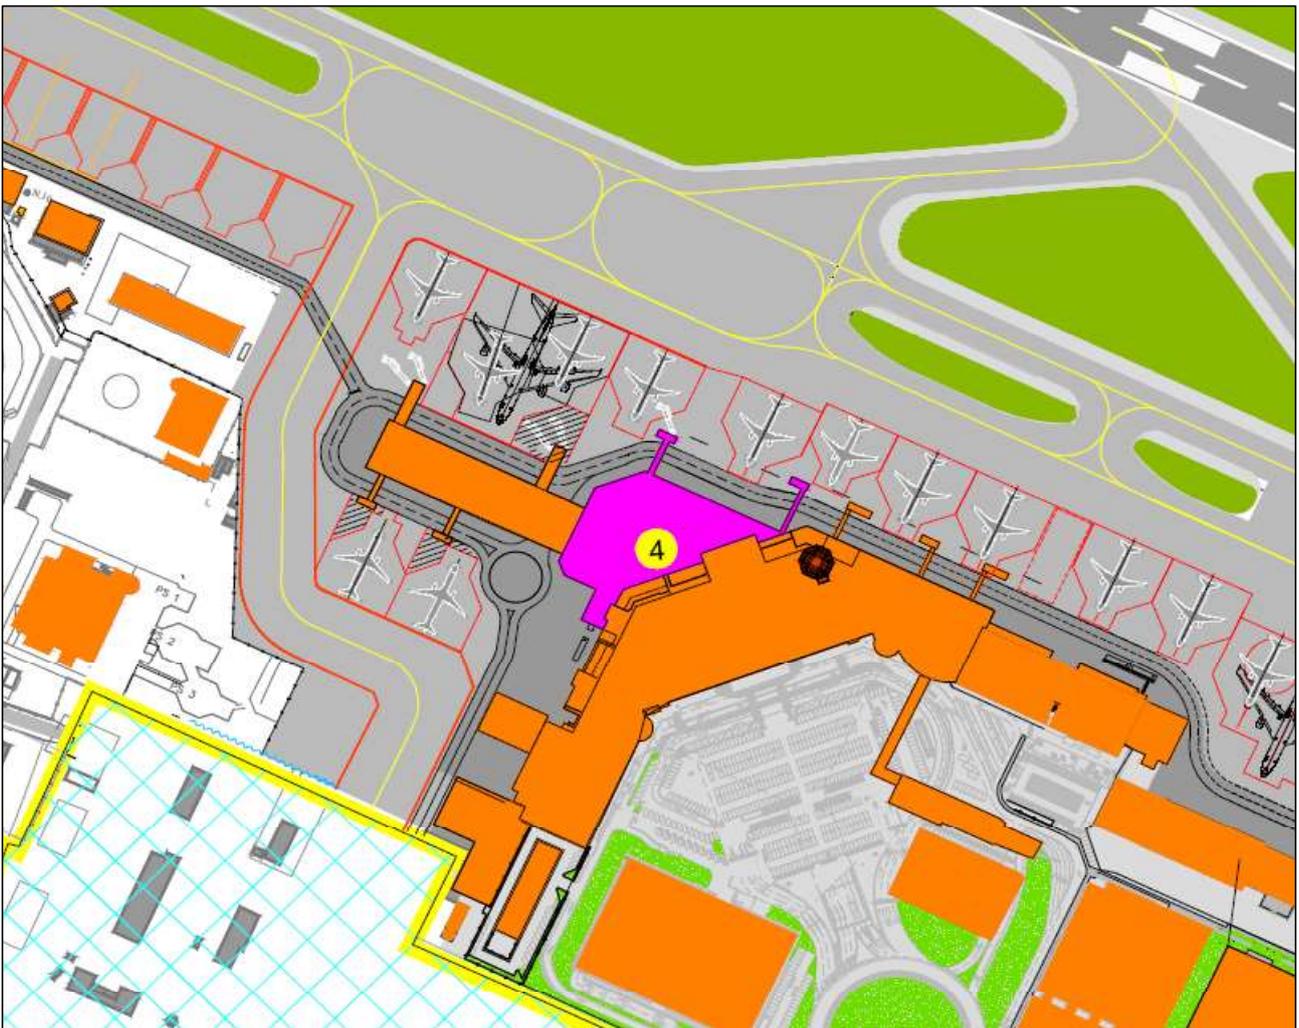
Estratto Master Plan – Ampliamento Terminal Fase 1
